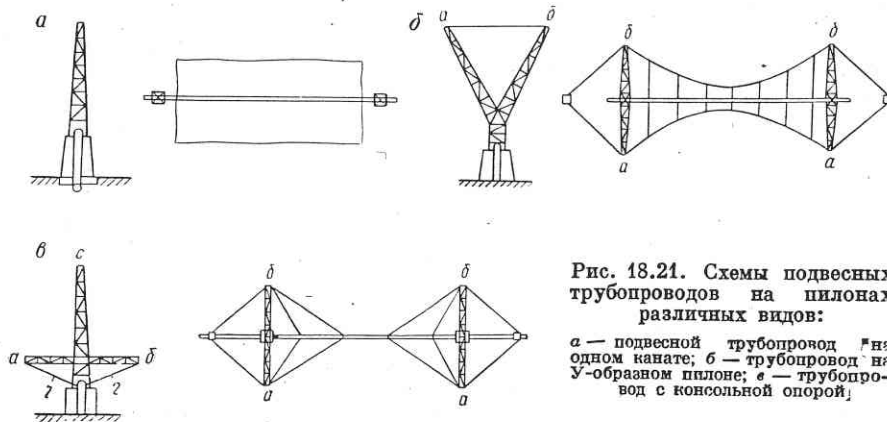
Схемы подвесных трубопроводов на пилонах различных видов:
